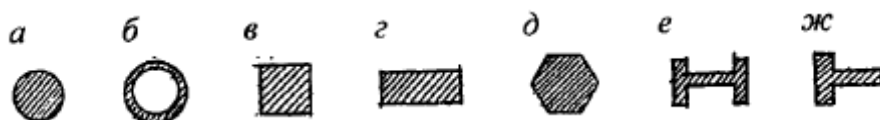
Сечения железобетонных свай: а - круглое; б- круглое пустотелое; в - квадратное; г - прямоугольное; д - многоугольное; е - двутавровое; ж - тавровое
